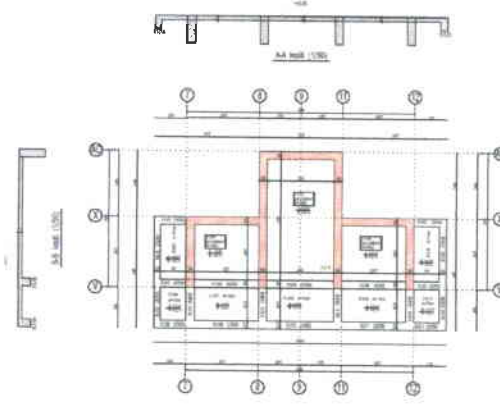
A 1 blok 1.Bodrum Kat Kalıp Planı
